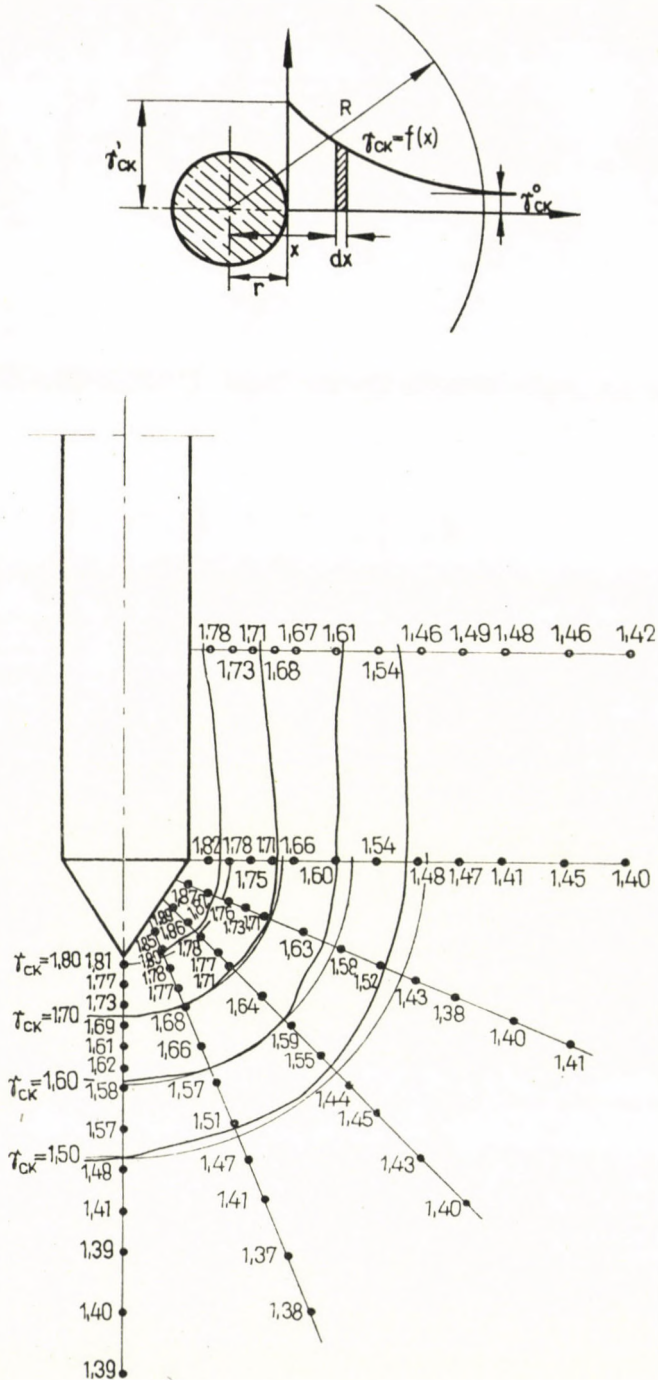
Зона уплотнения грунта вокруг сваи. а) схема к определению радиуса уплотненной зоны, б) распределение плотности грунта по опытным данным
